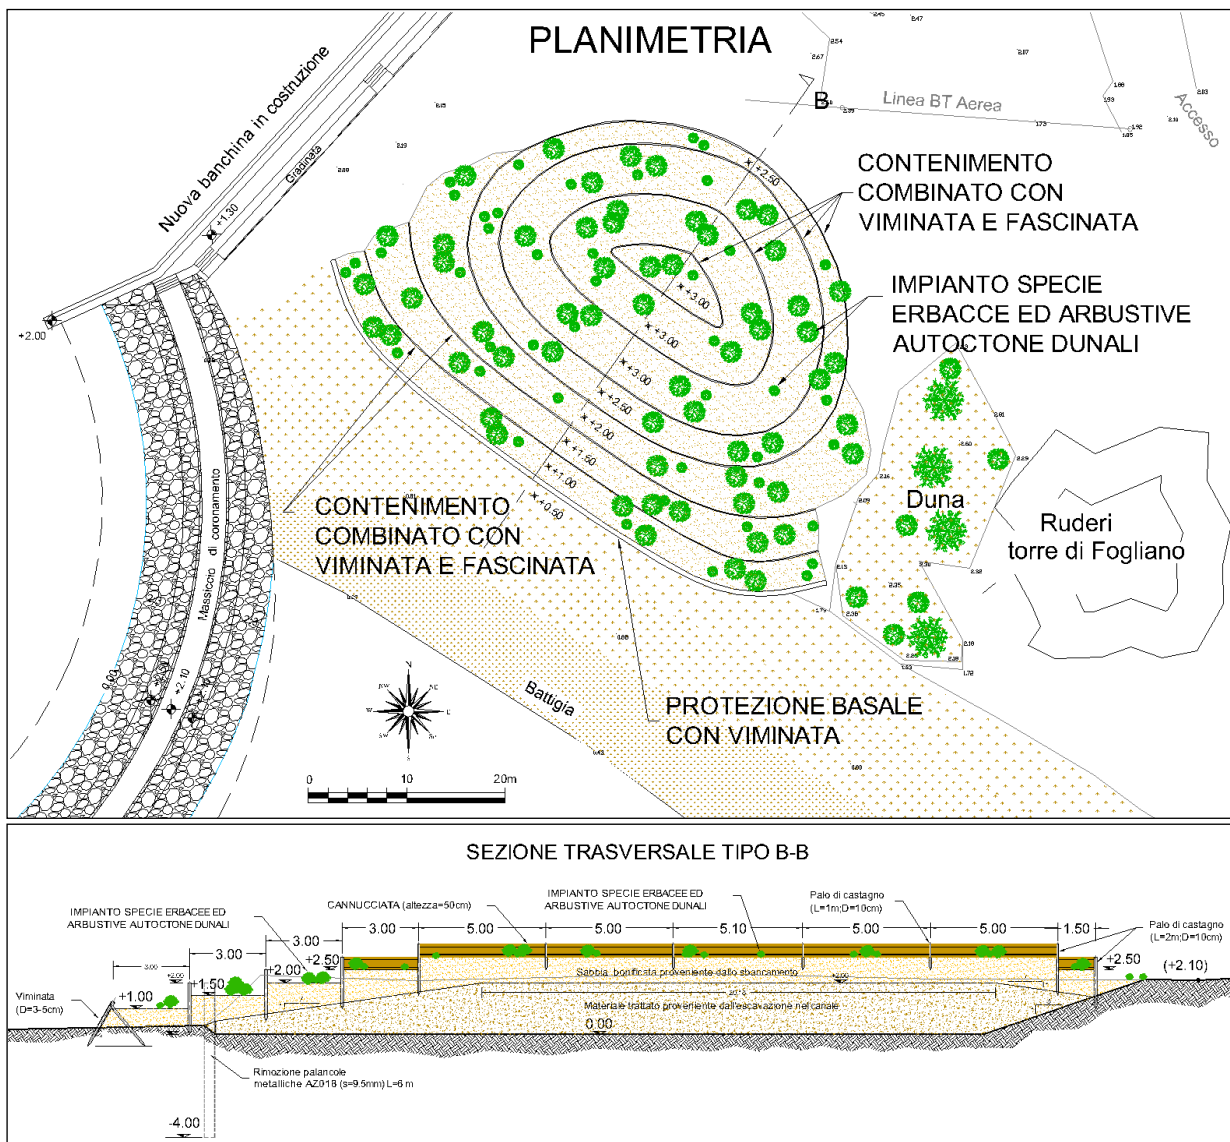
Ripristino del cordone dunale lato Sabaudia. Planimetria e sezione tipo
